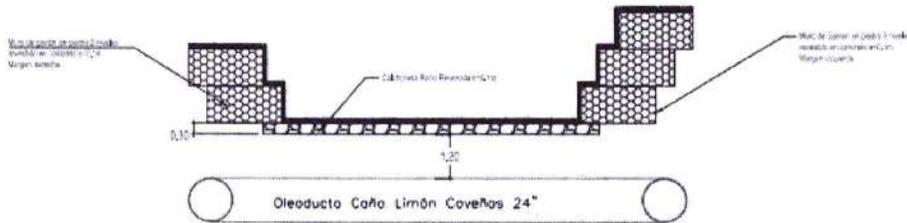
Esquema en perfil transversal de las obras a ejecutar en el Drenaje_NN_01, en el cruce subfluvial del sistema del Oleoducto Caño Limón – Coveñas (PK 492+625). Fuente: CENIT, 2022.
